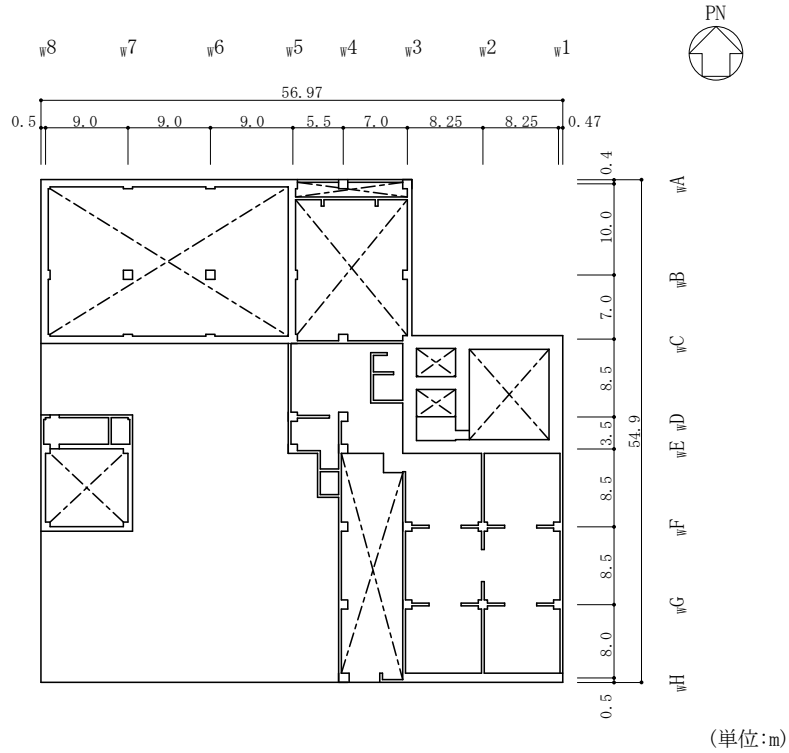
(8) 廃棄物処理建物の概略平面図 (EL 37.5m)
